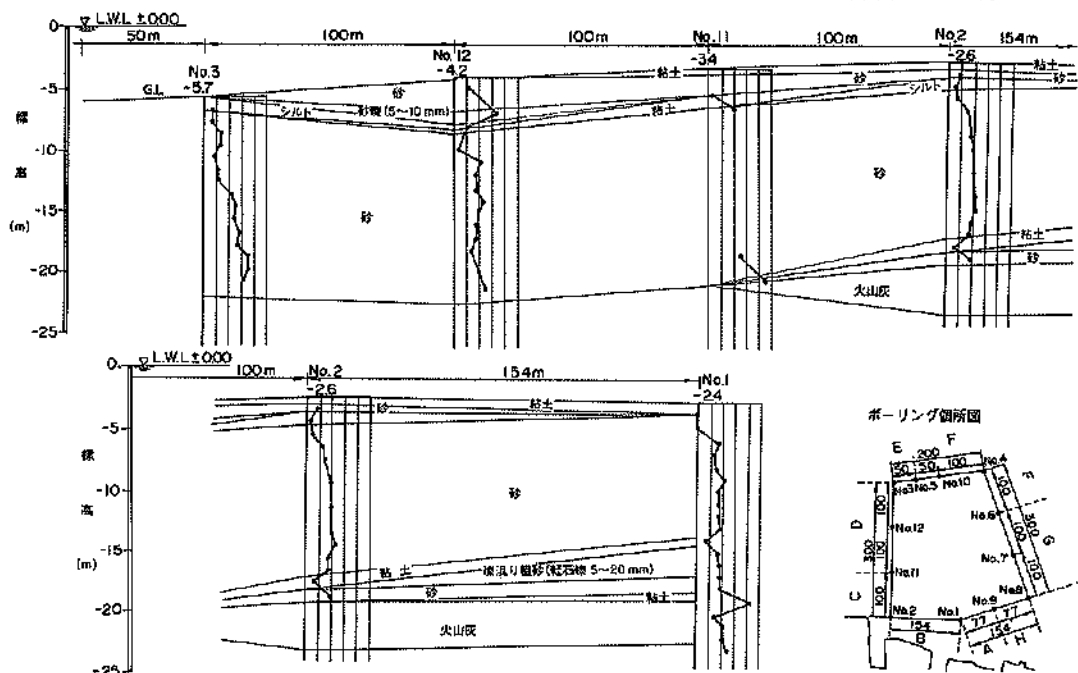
(a) 大町地区土砂処分場平面図および土質断面図
